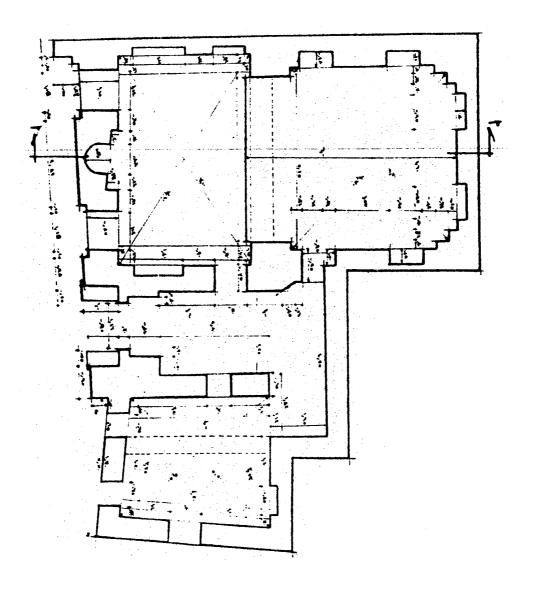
مسقط أفقي للمشهد القبلي باسوان (عن : Villard) .
